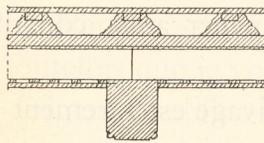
Plancher sur poutres apparentes en contre-bas des solives.
